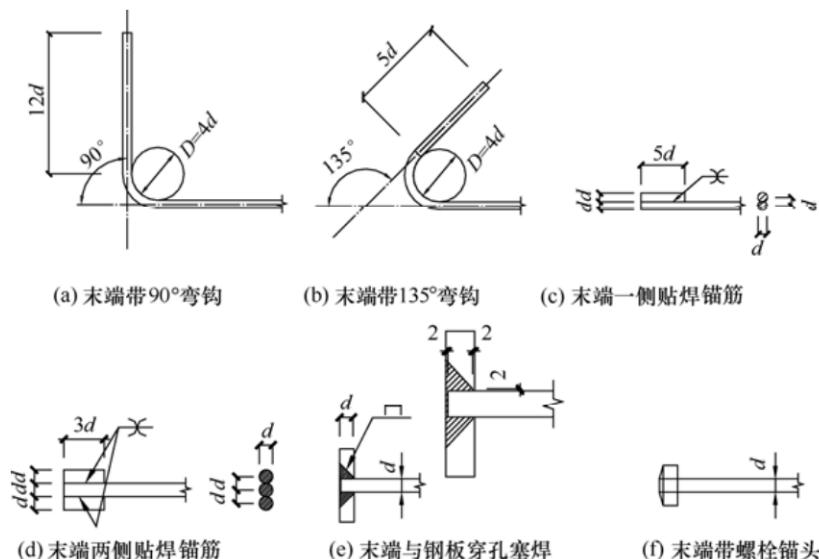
钢筋弯钩和机械锚固的形式与技术要求
